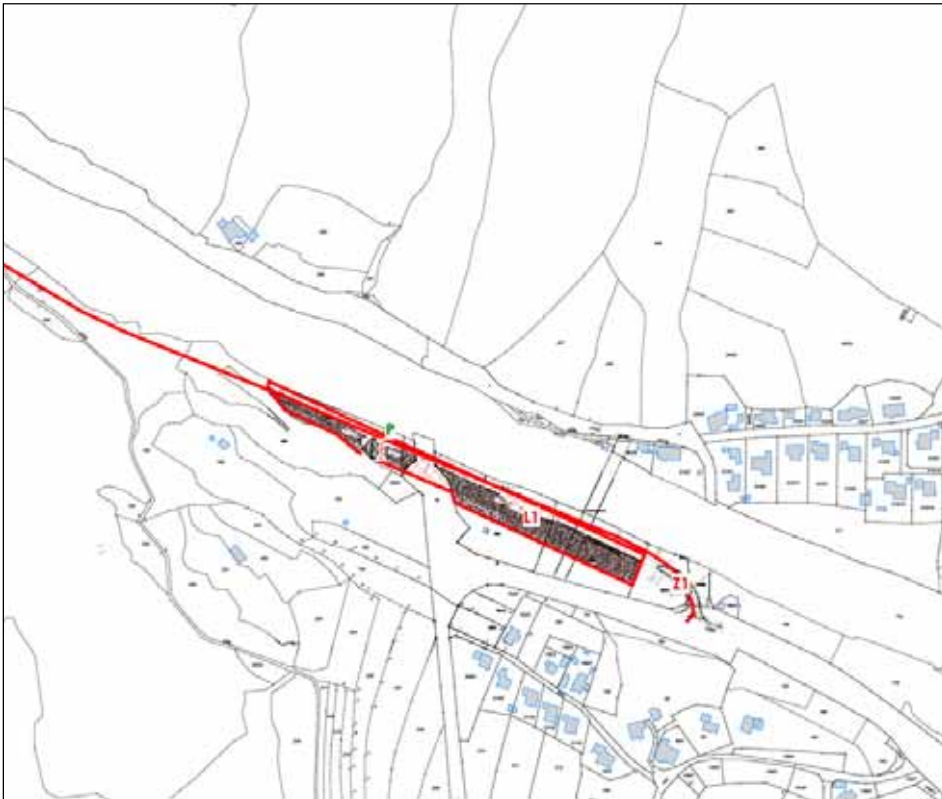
Lageplan mit Darstellung der Schallquellen für den Baustellenbetrieb V2
